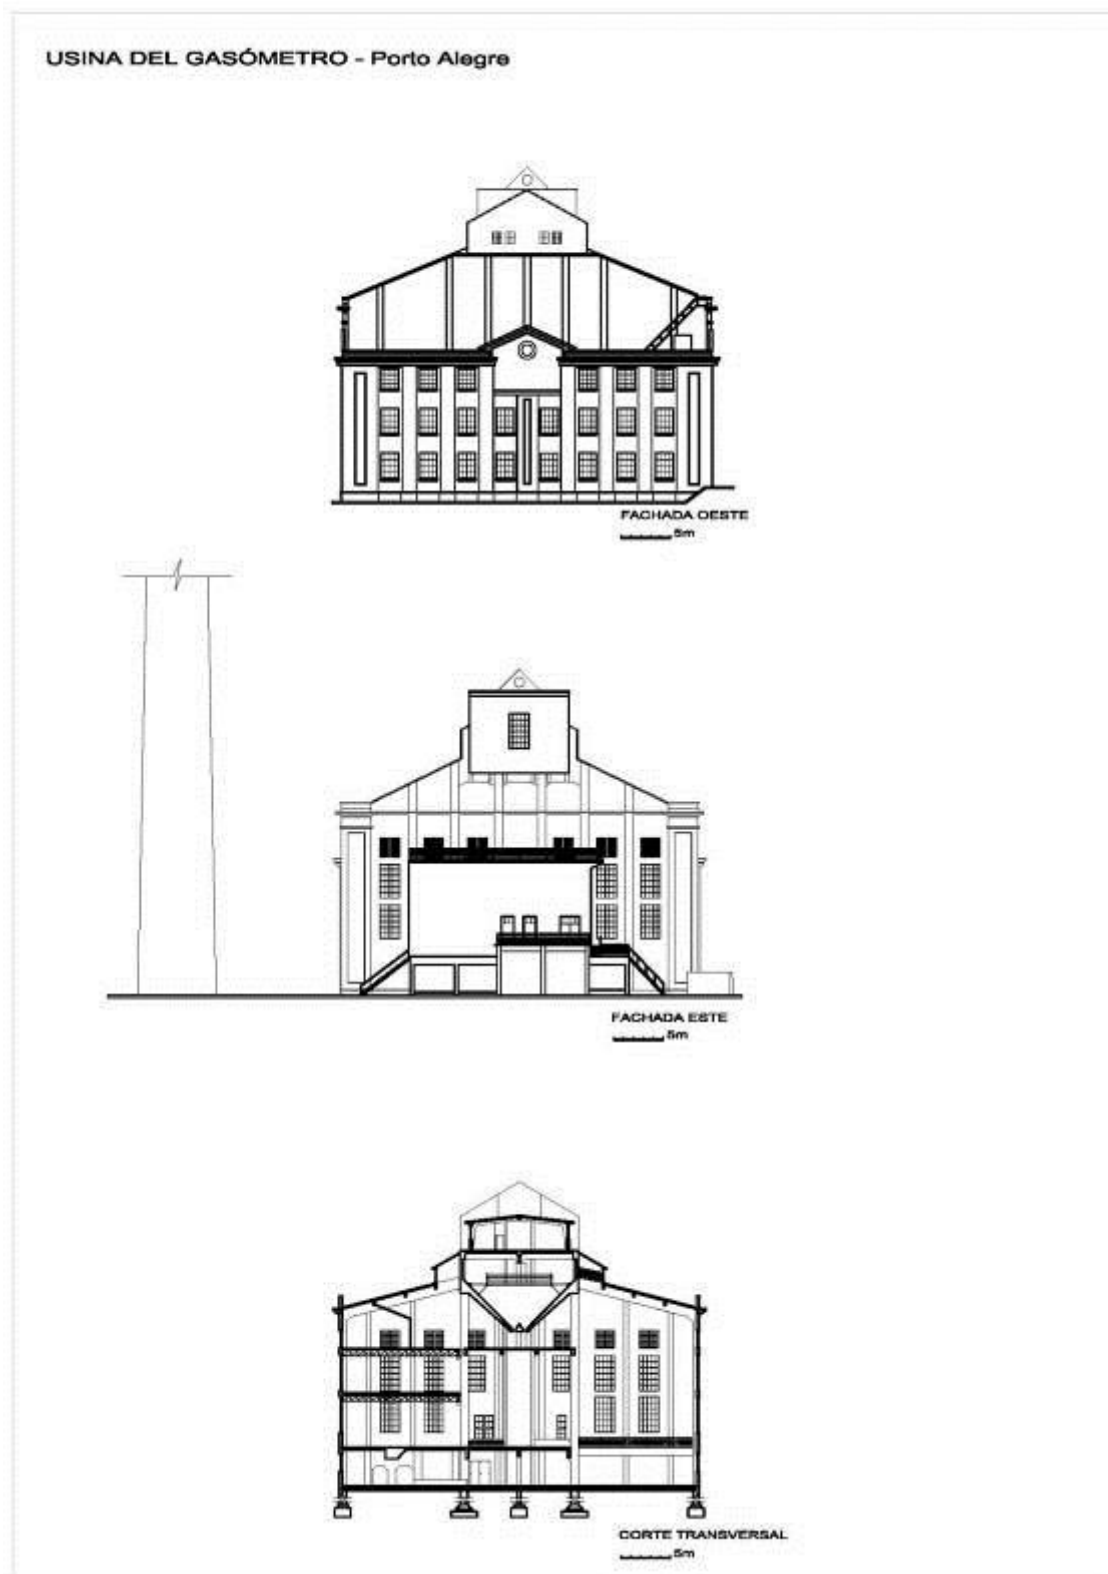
Usina del Gasómetro. Proyecto de restauración. Fachadas y corte transversales.
